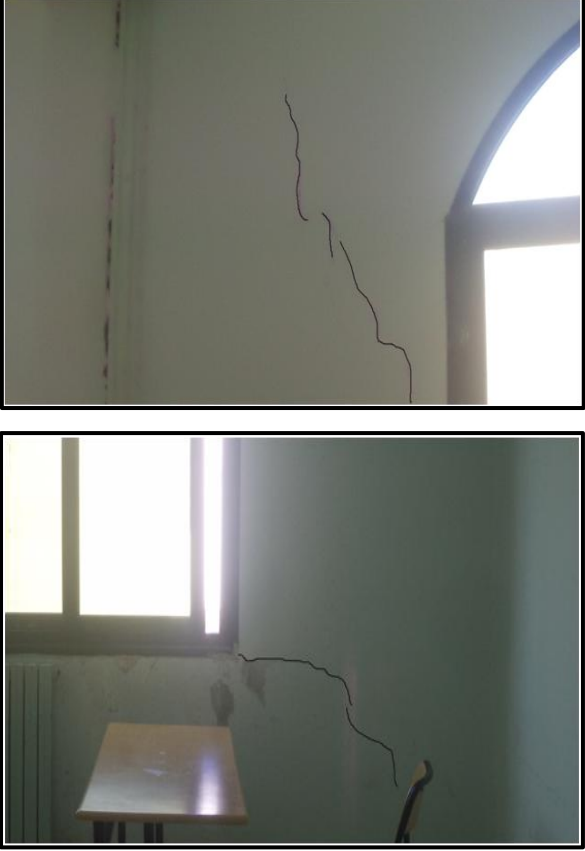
Indication sur les plans, des fissures apparues dans les cloisons intérieures.
